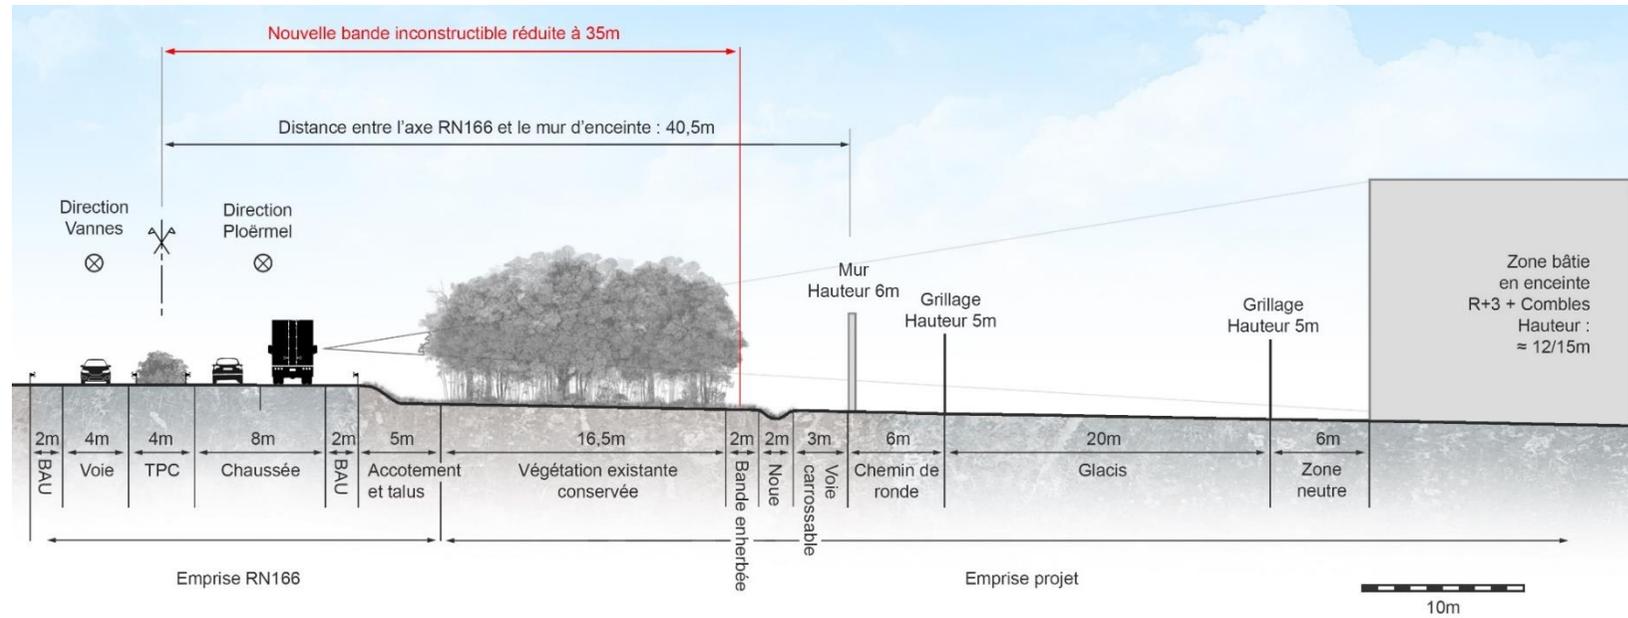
Coupe paysagère ouest : nouvelle bande inconstructible avec préservation d'une partie de la haie arborescente
